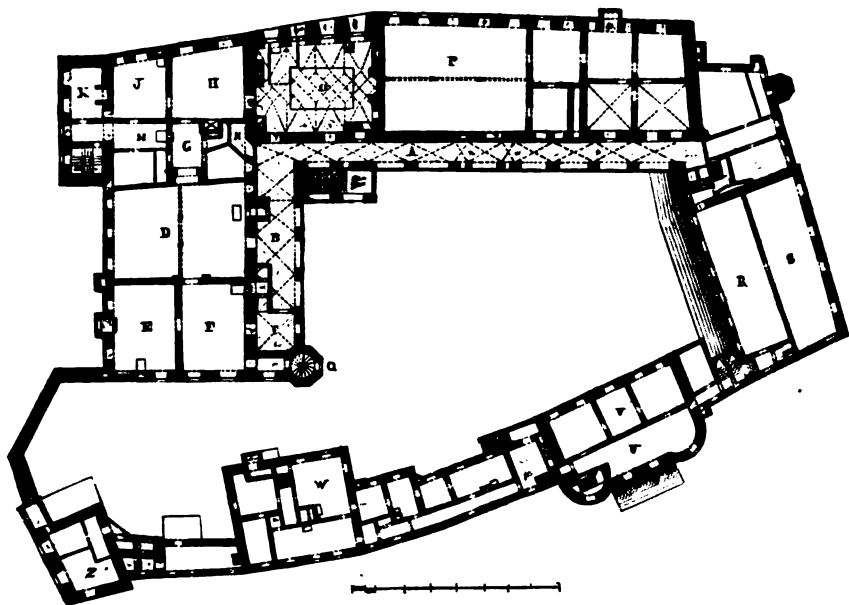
Trausnitz. Grundriss des ersten Stockes.
